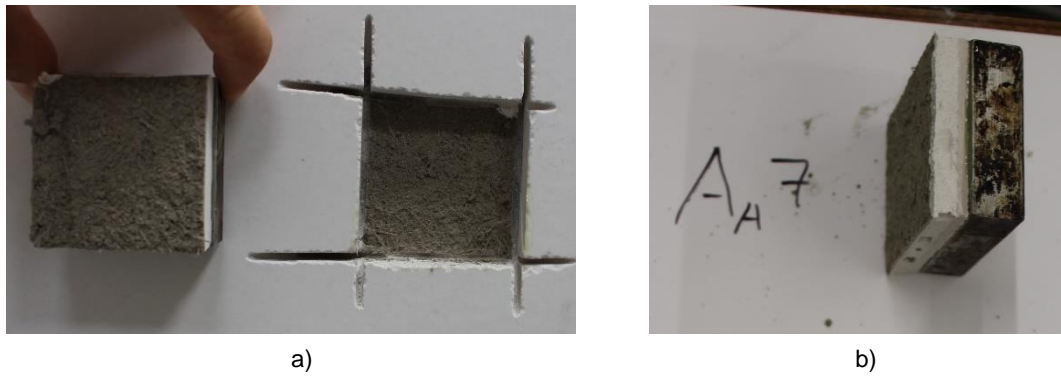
Ensaio de aderência Aa7: a) Vista de frente; b) Vista em perfil
